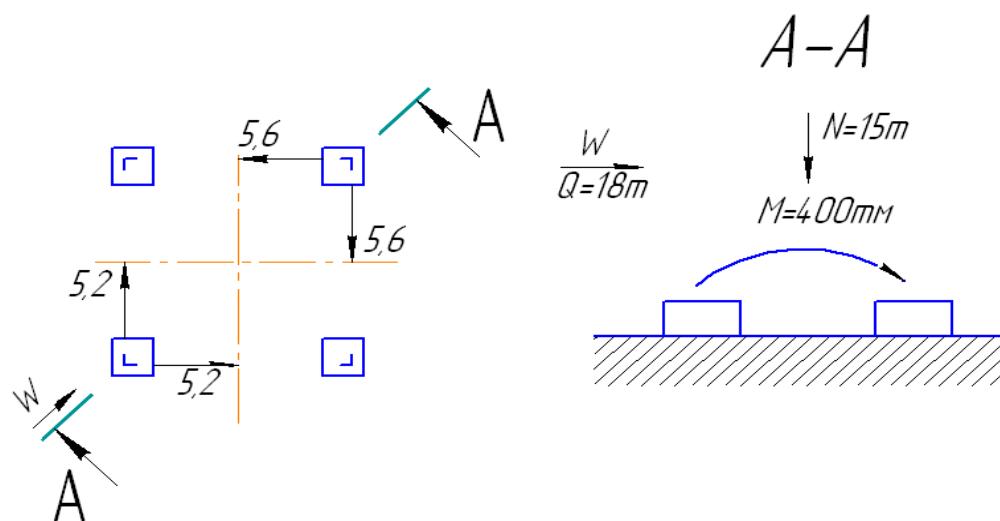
Схема нагрузок, действующих на фундамент ОА
